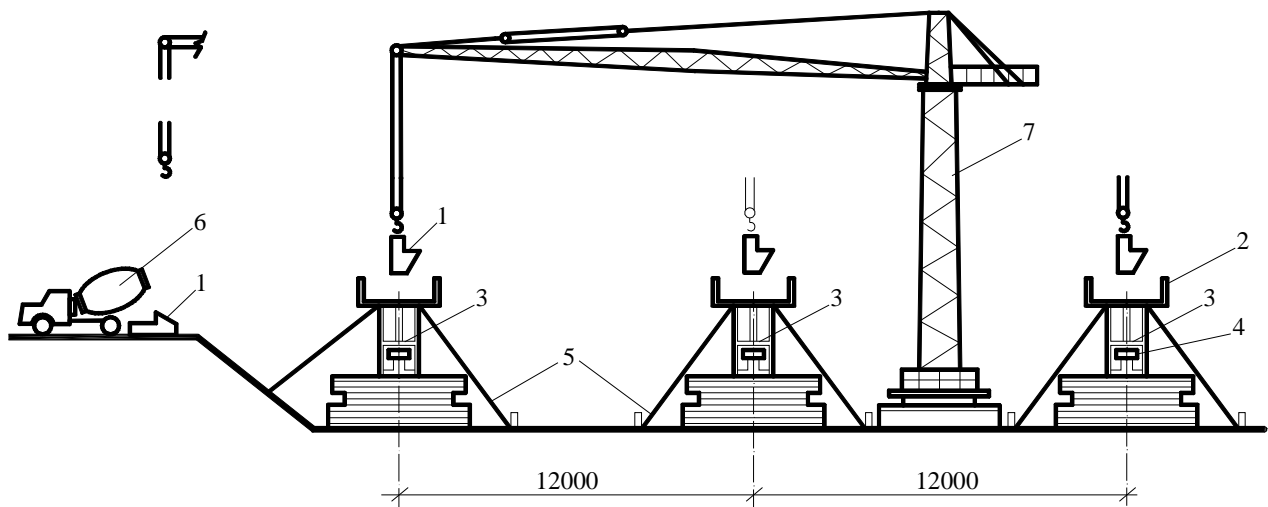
Схема подачі бетону у конструкцію кран-контейнер (кран-цебро): 1 – баддя; 2 – підмостки; 3 – опалубка; 4 – хобіт; 5 – відтяжки; 6 – автомобетонівіз; 7 – кран
